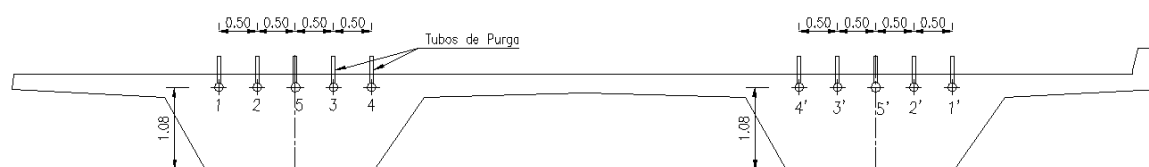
Disposição transversal dos cabos de pré-esforço [6]
